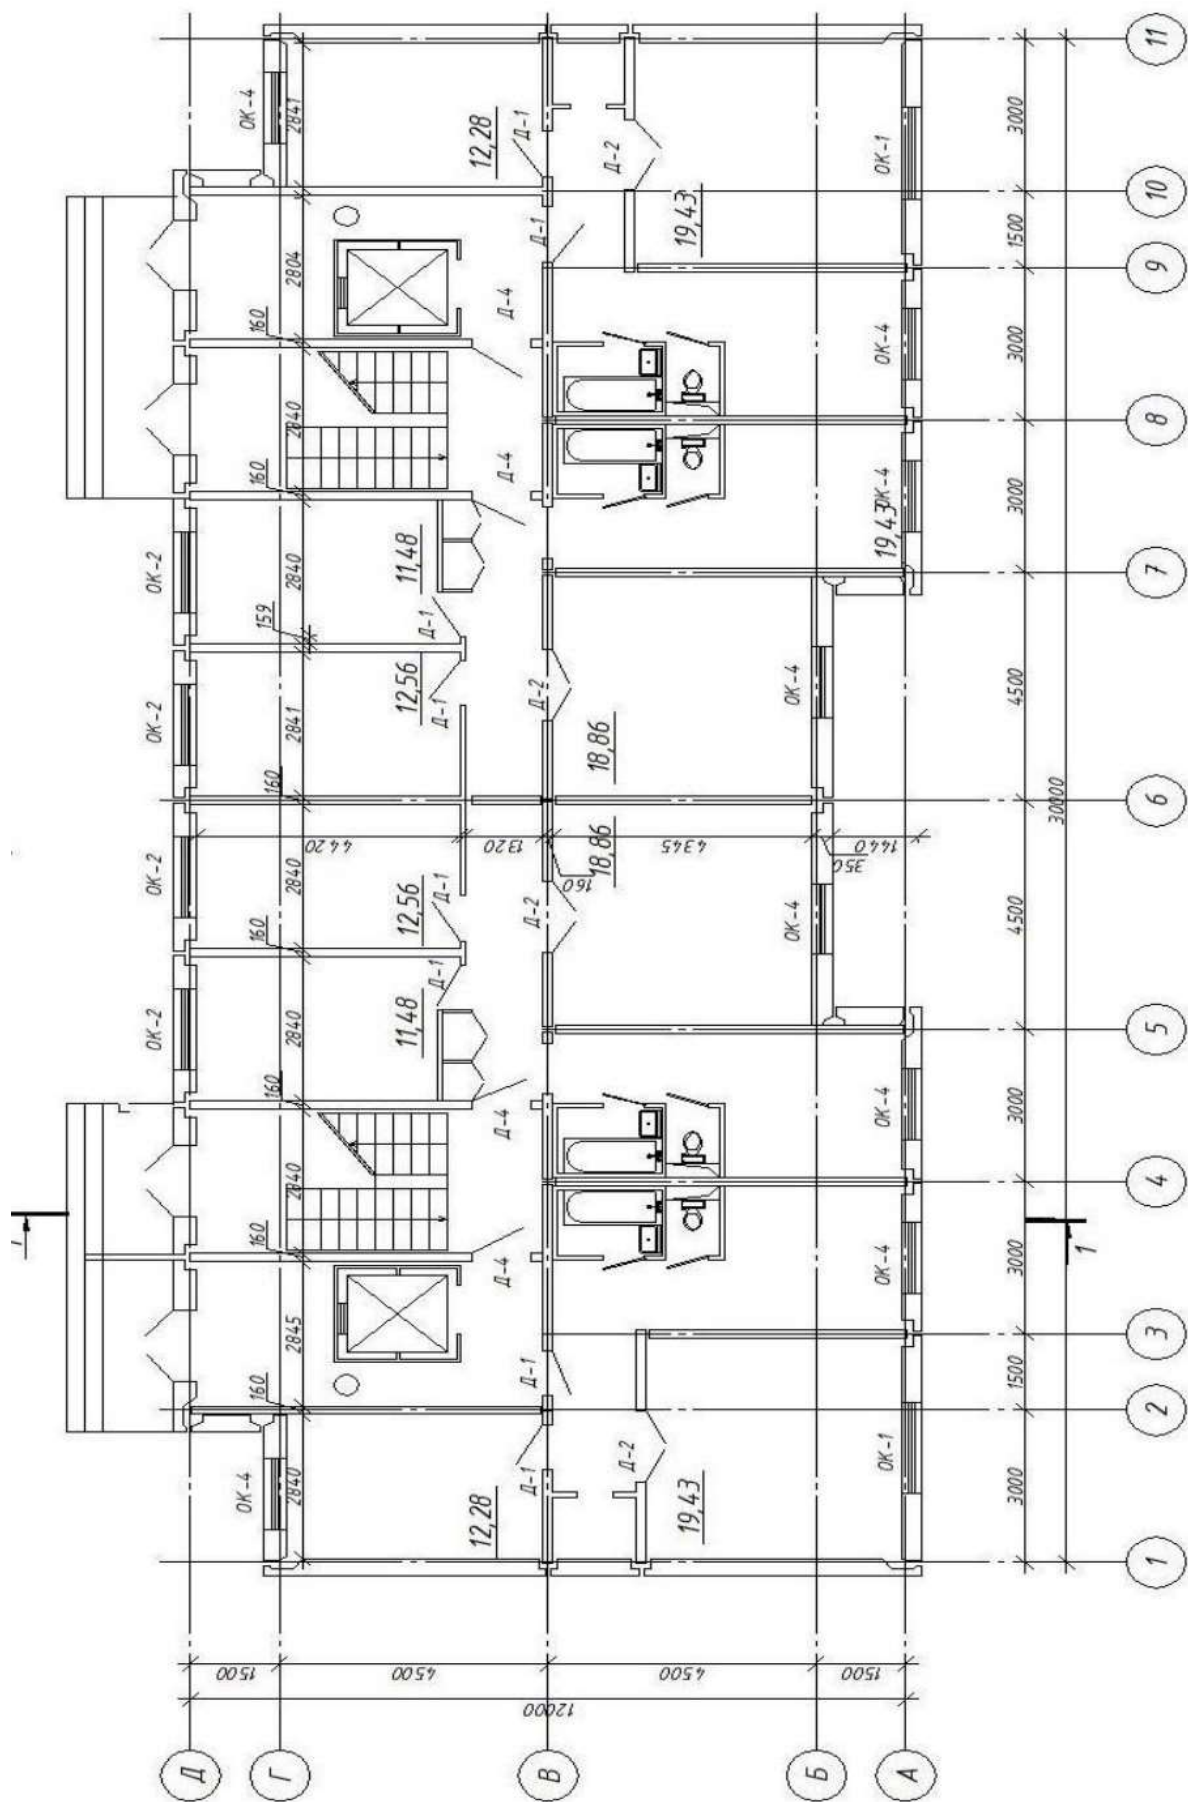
Приклад виконання плану 1-го поверху будівлі
